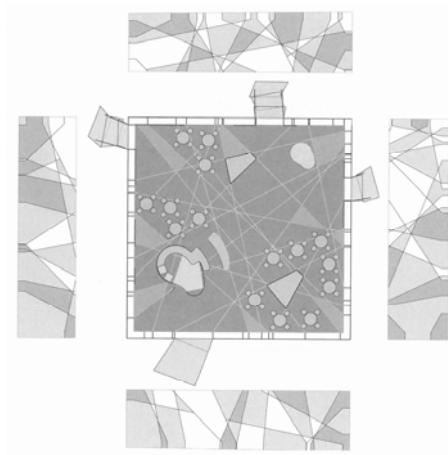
Planta e alçados, pavilhão de Toyo Ito, 2002.
